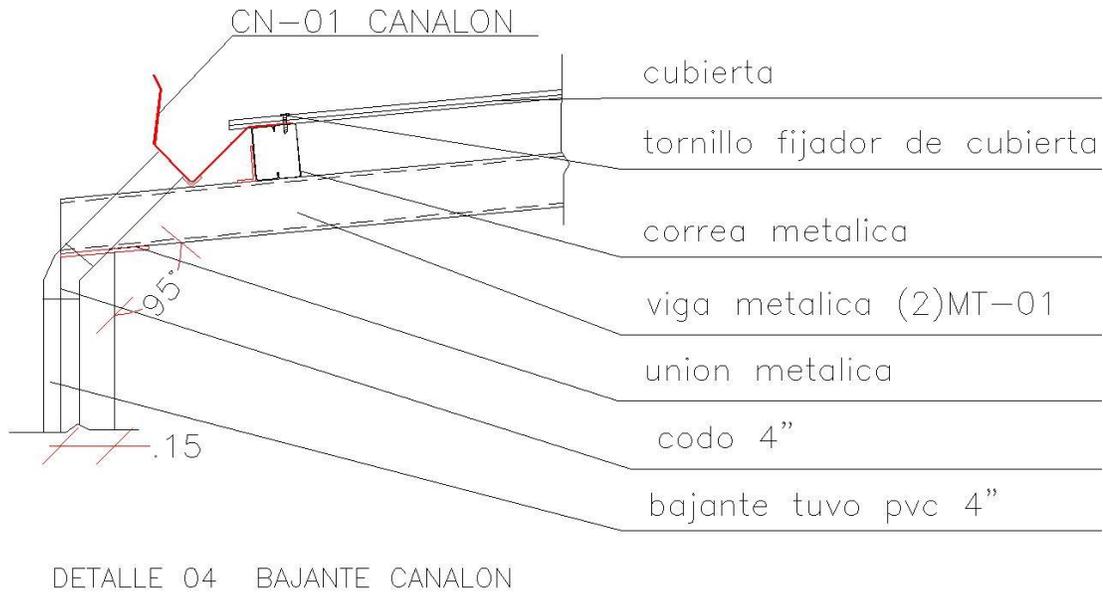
Estructura metálica del ancla del muro prefabricado bajante canalón.
